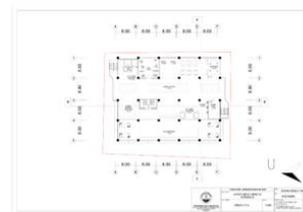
Denah Lantai 1 (Sumber : Dokumentasi Pribadi)
